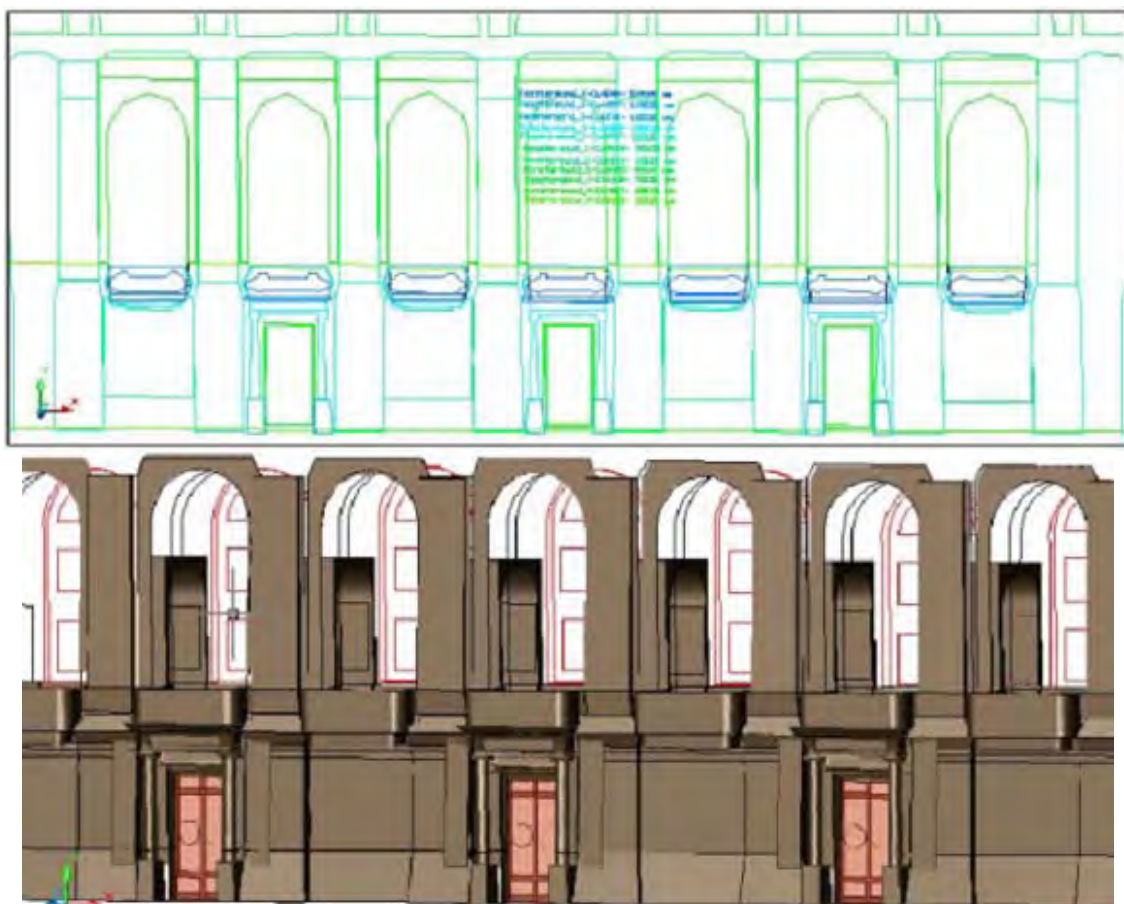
Konstruktion der Seitenwand des Festsaaes: 2D-Plan mit Real Works Survey (oben) und 3D-Modell mit LFM Server und AutoCAD (unten) erstellt
